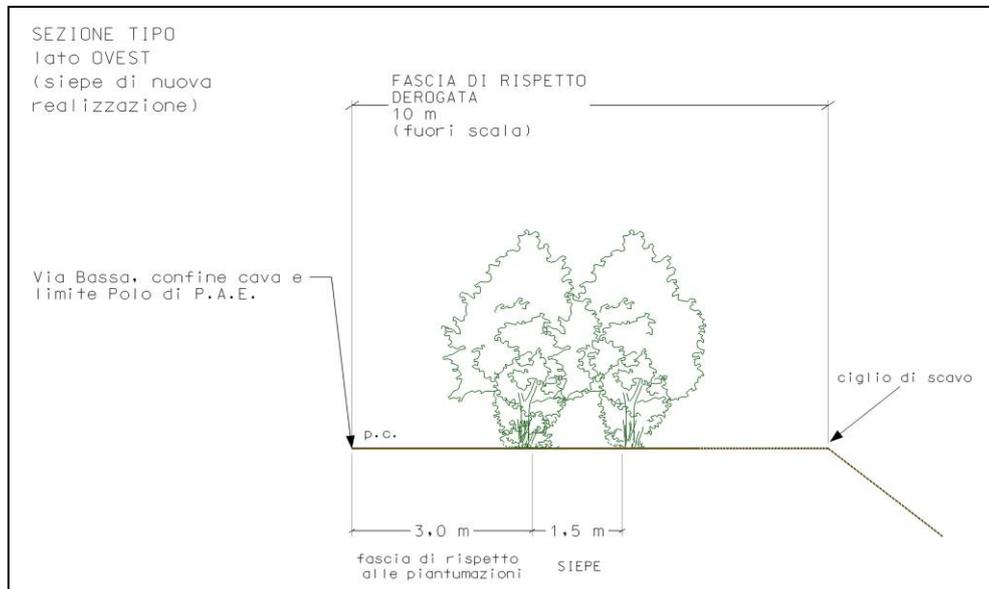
Sezione tipo della siepe sul lato Ovest.
